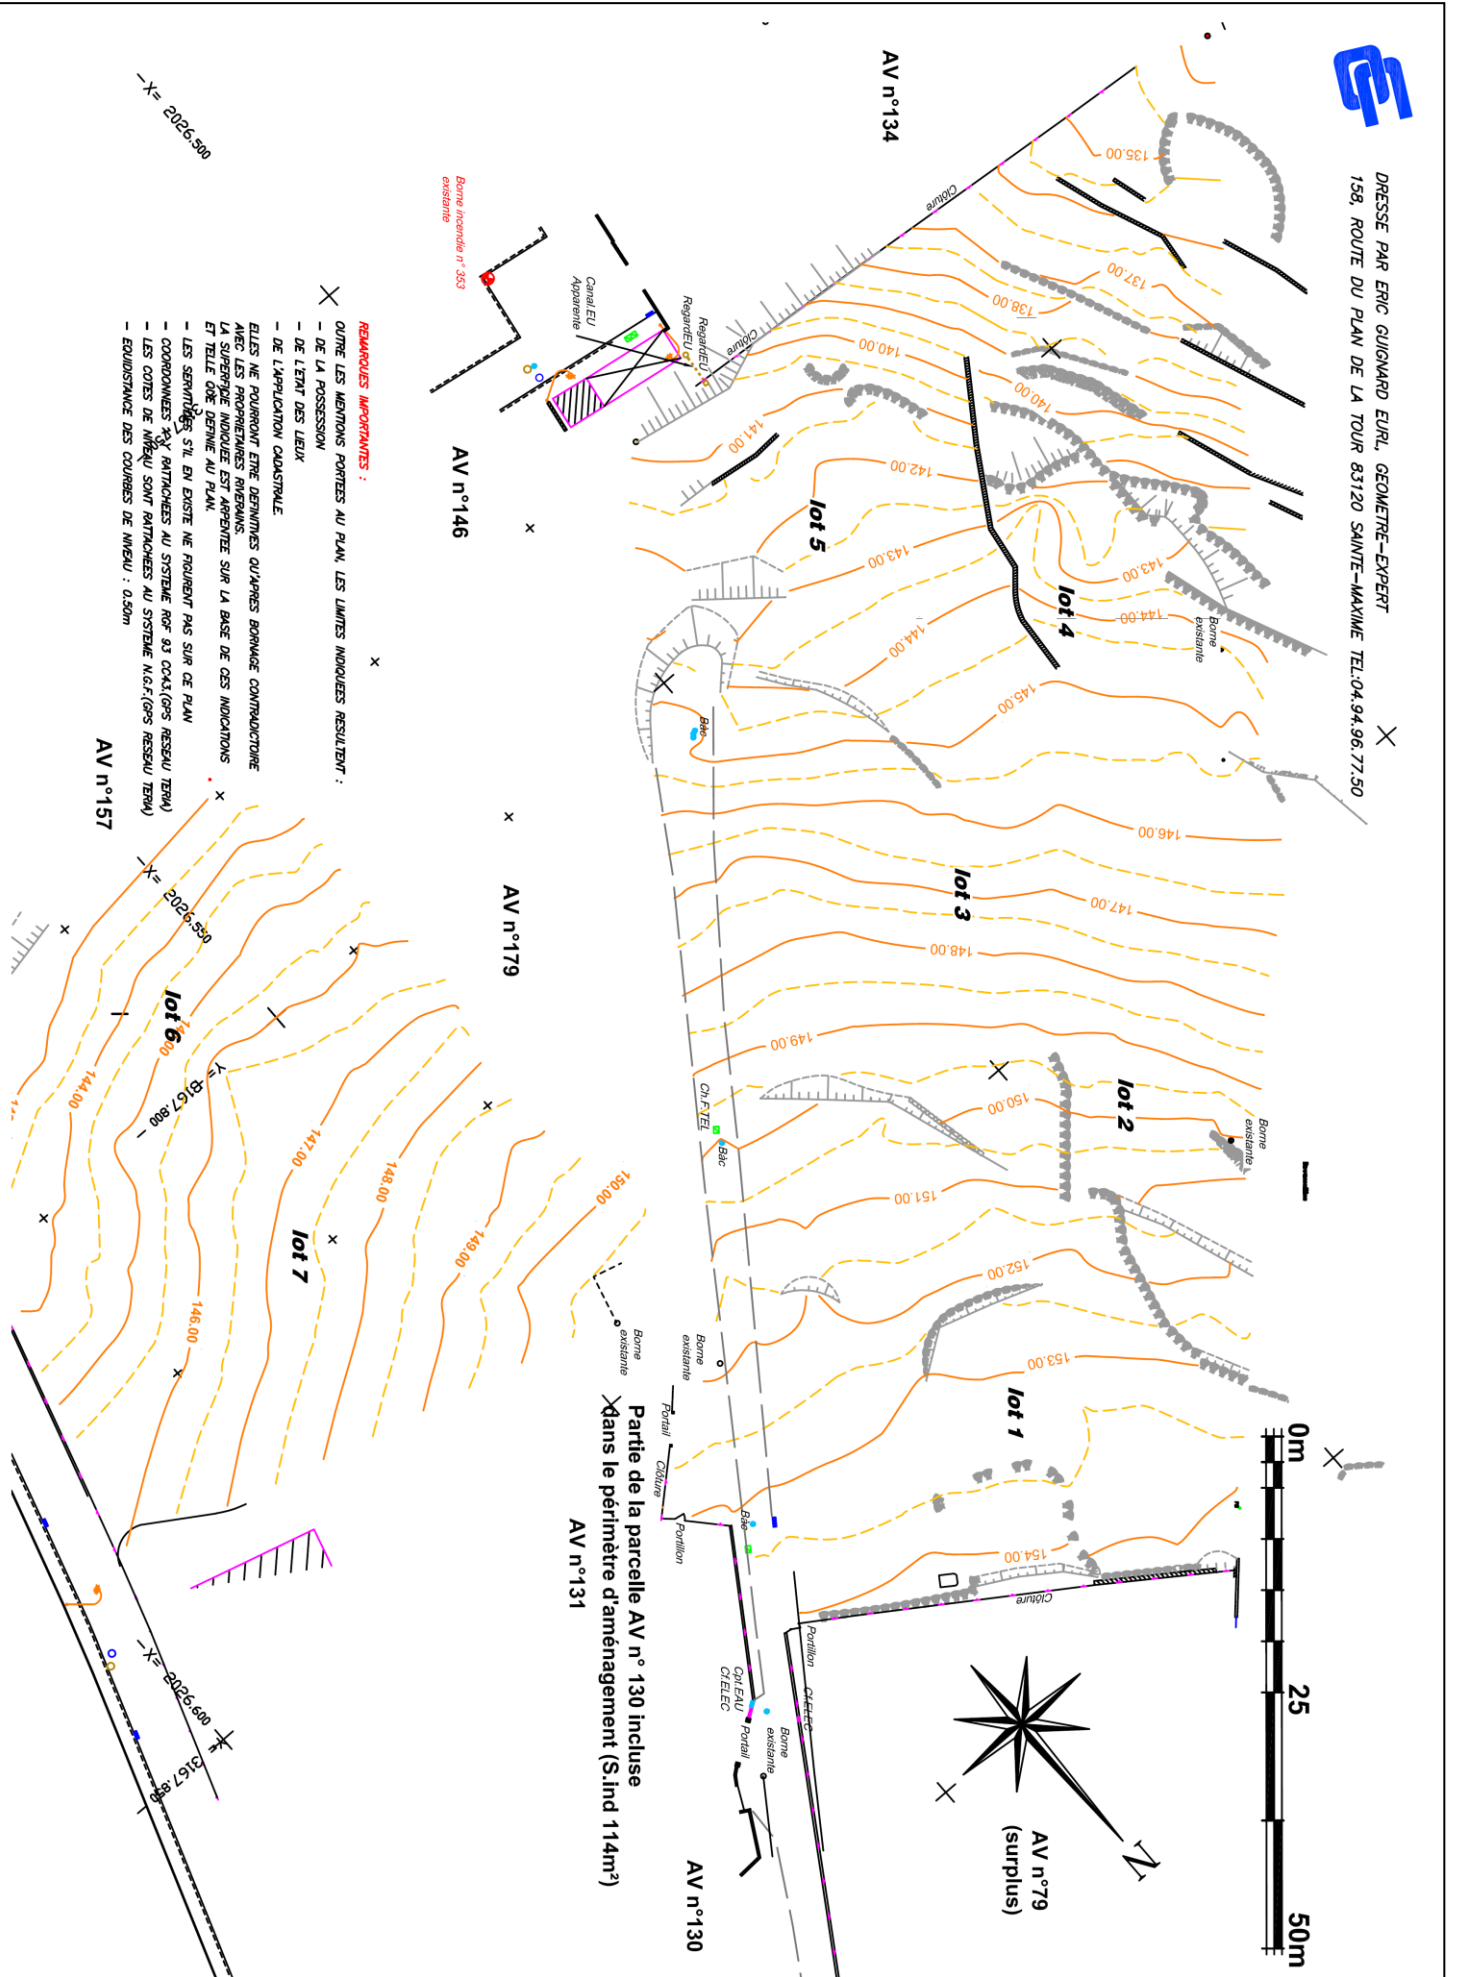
Plan de masse de l'existant (plan du géomètre)
